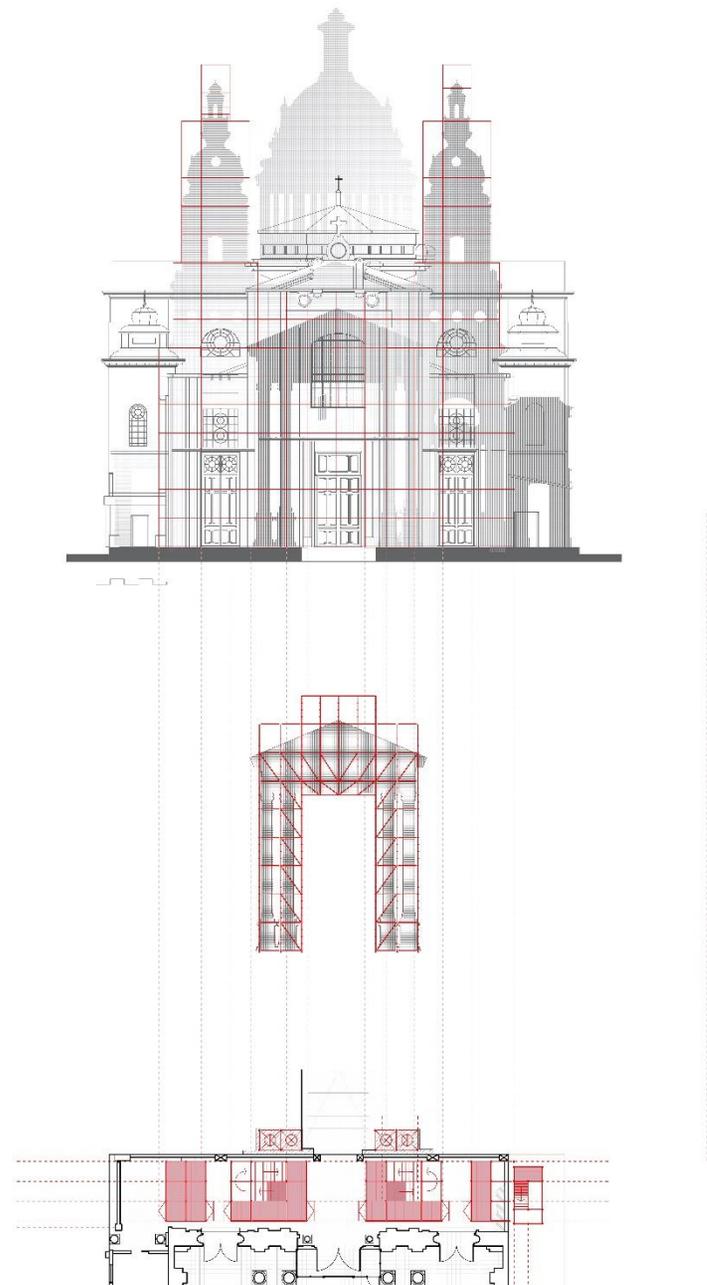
Primer planteamiento del proyecto, esquematización de cómo se construye el volumen de la fachada.
